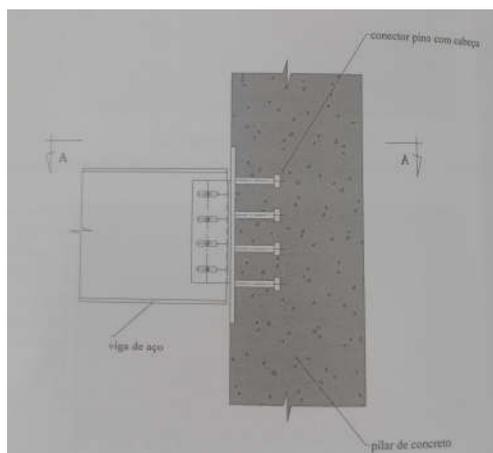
Ligação de viga metálica em pilar de concreto armado
